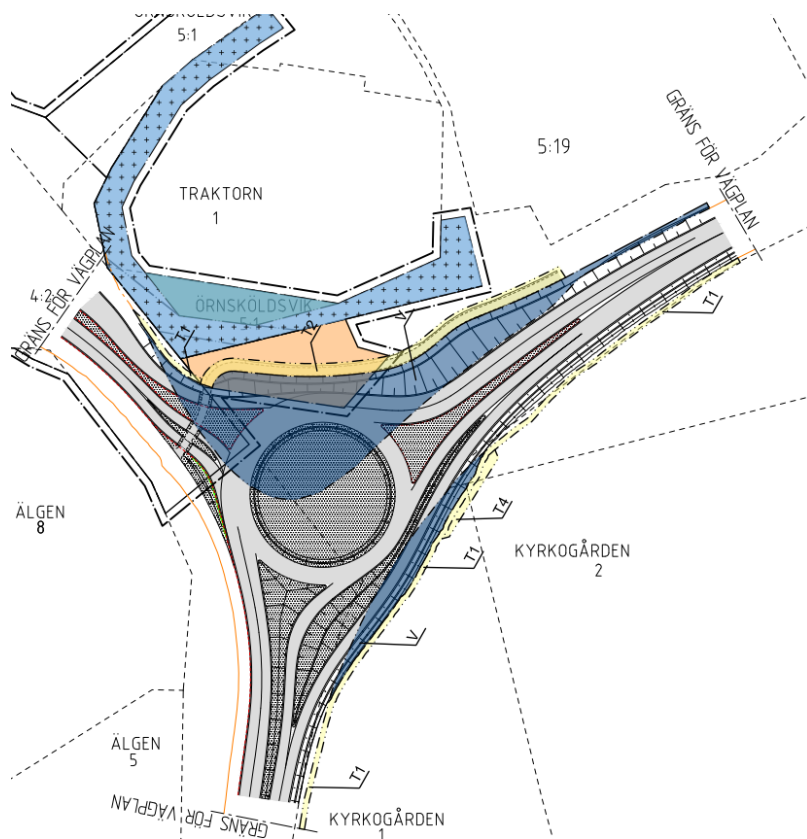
Stadsplan 2284K-1247 med planförslaget. (Ej skalendig)
